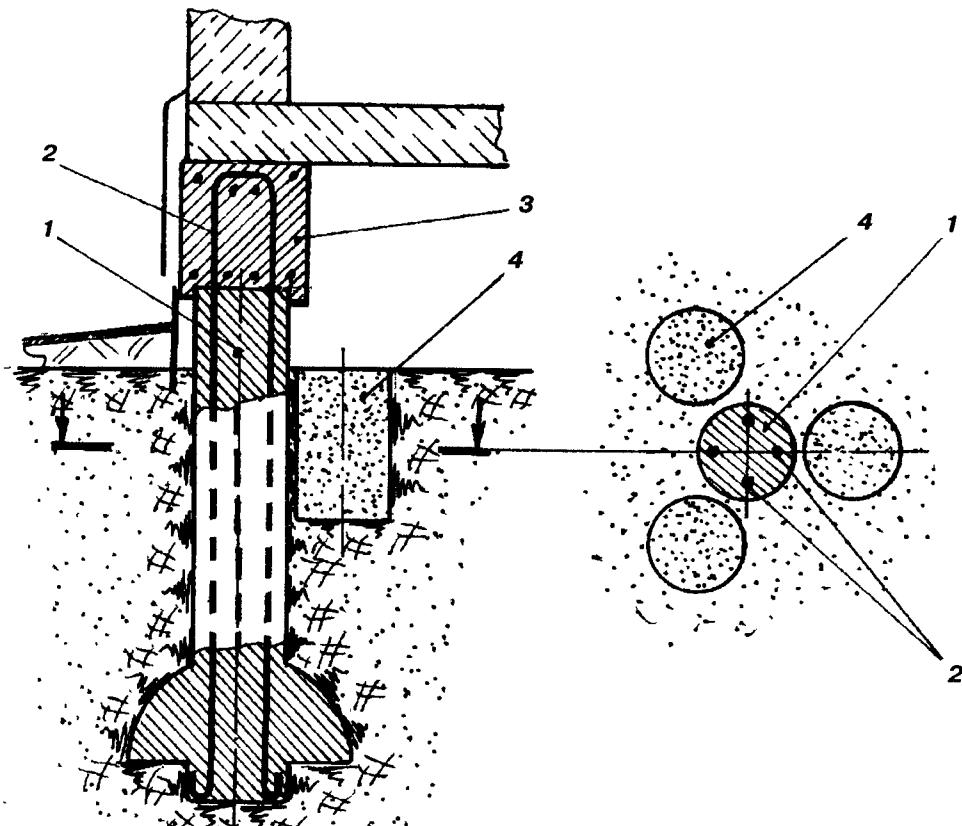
Сейсмоизолирующий фундамент с арматурными скобами:
